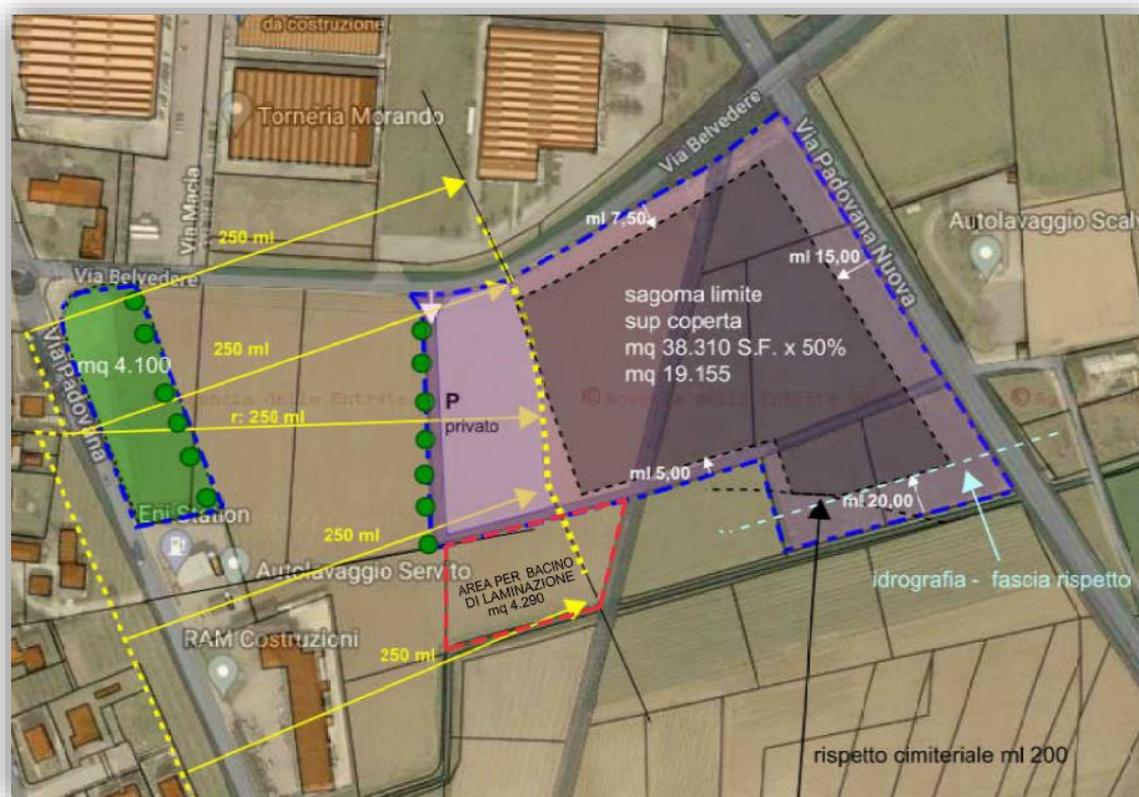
Individuazione planimetrica del bacino di laminazione
